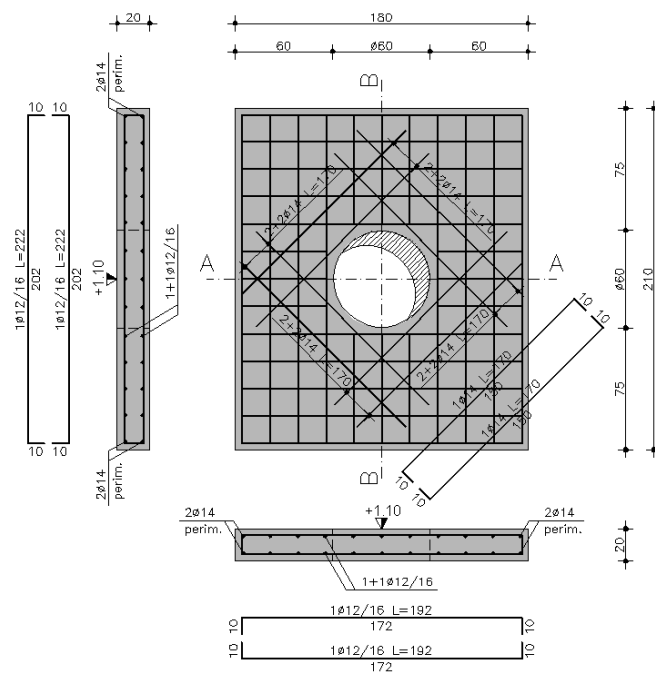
Pozzetto n. 2 - Pianta coperto appoggiato
